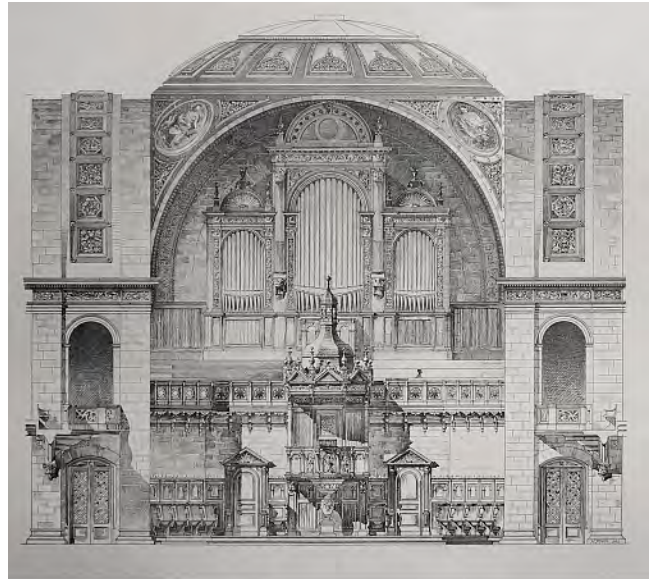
, 11: Zürich, ref. Kirche Enge. Schnitt mit Blick zur Kanzelwand und Grundriss. – SBZ 25 (1895), 33, 40).
